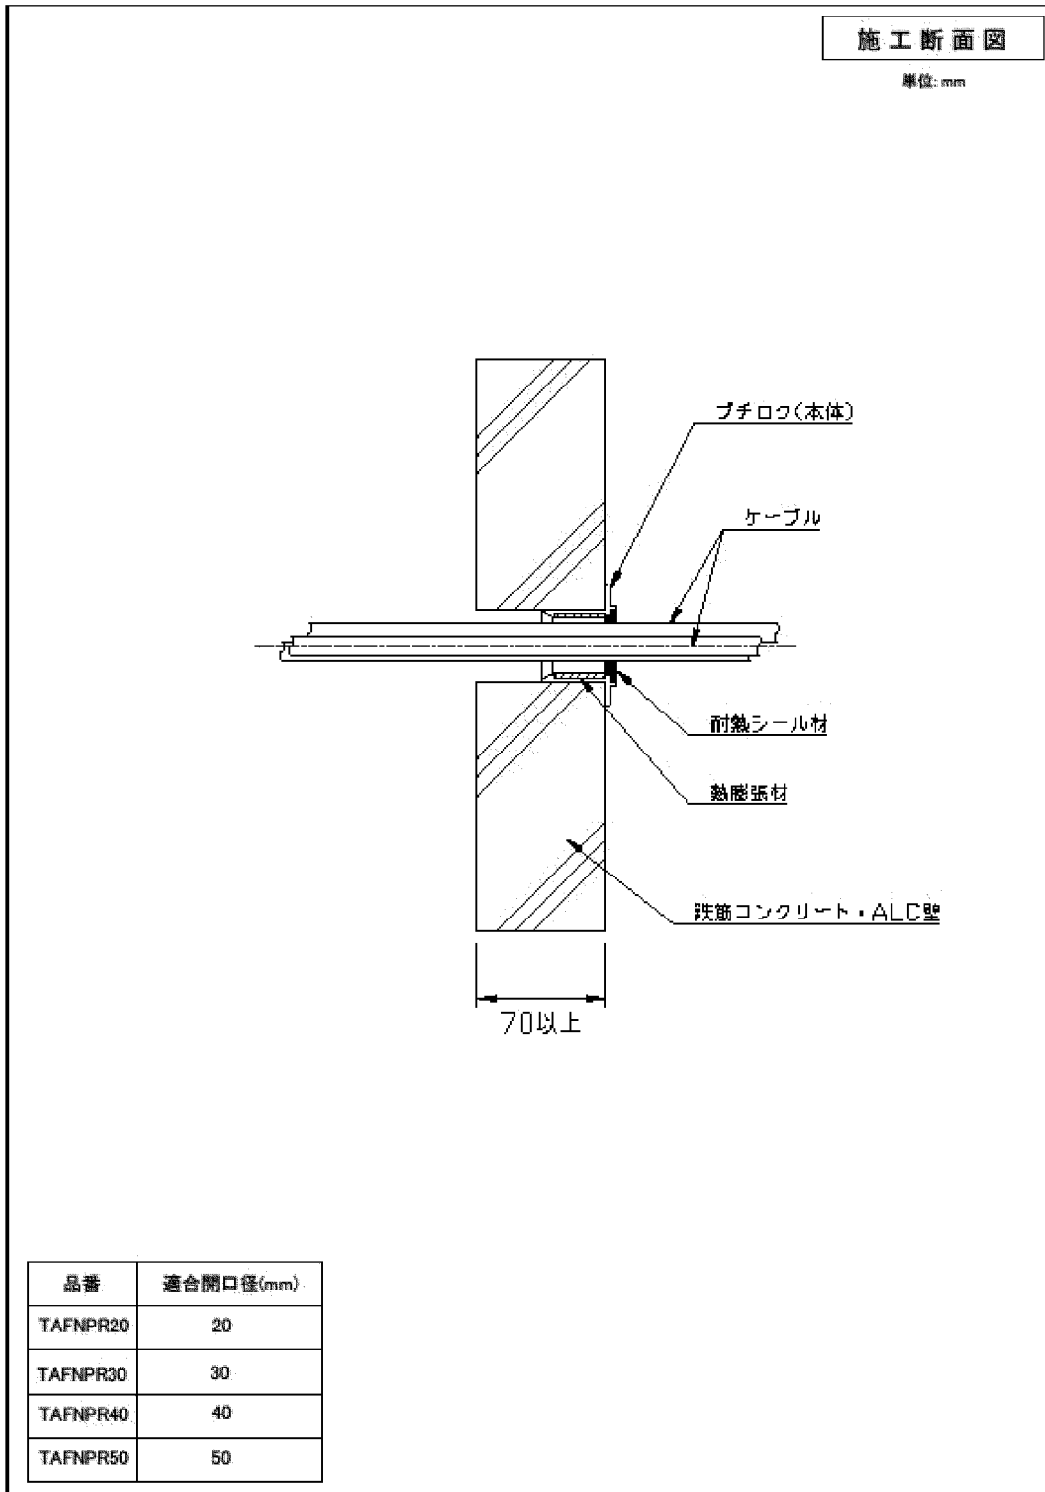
鉄筋コンクリート(RC)・ALC 壁(PS060WL-0435)標準施工図
